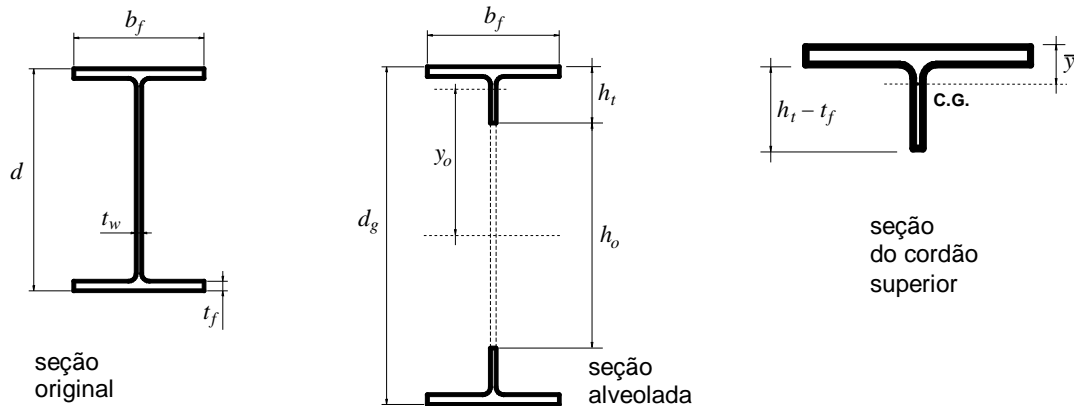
Identificação dos elementos das seções transversais (SILVEIRA, 2011).
